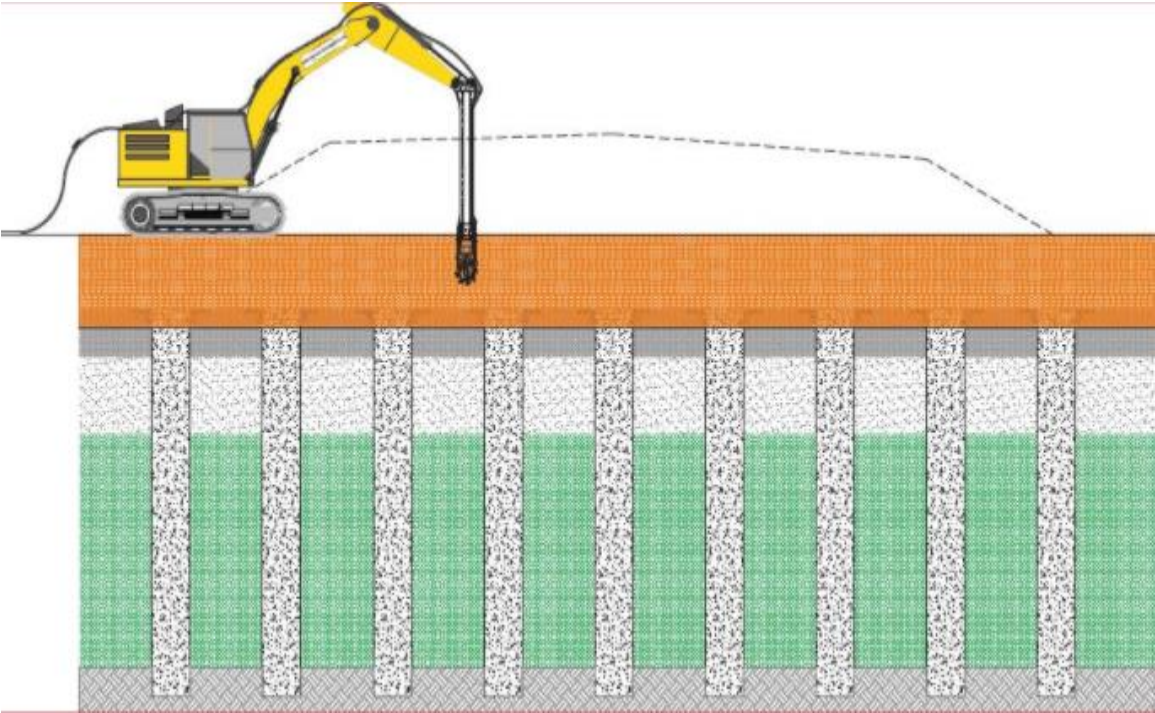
Show stabilizing ground under planned retaining wall with MSM. Illustration from (Covicorp, 2020).
